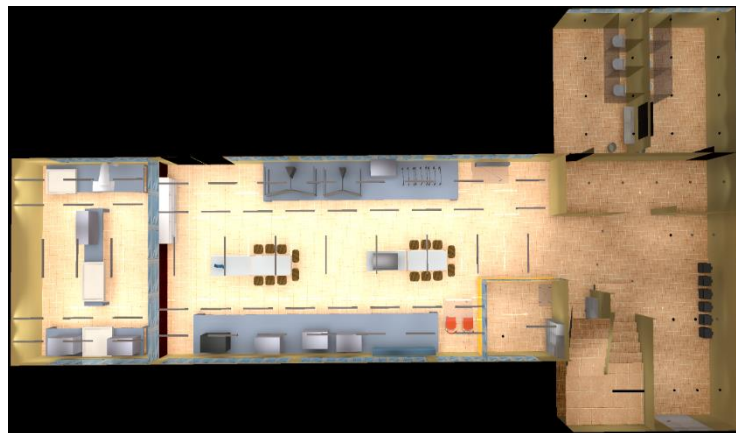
Vista 3D del rediseño de la iluminación de la planta baja del edificio de “tres niveles”
